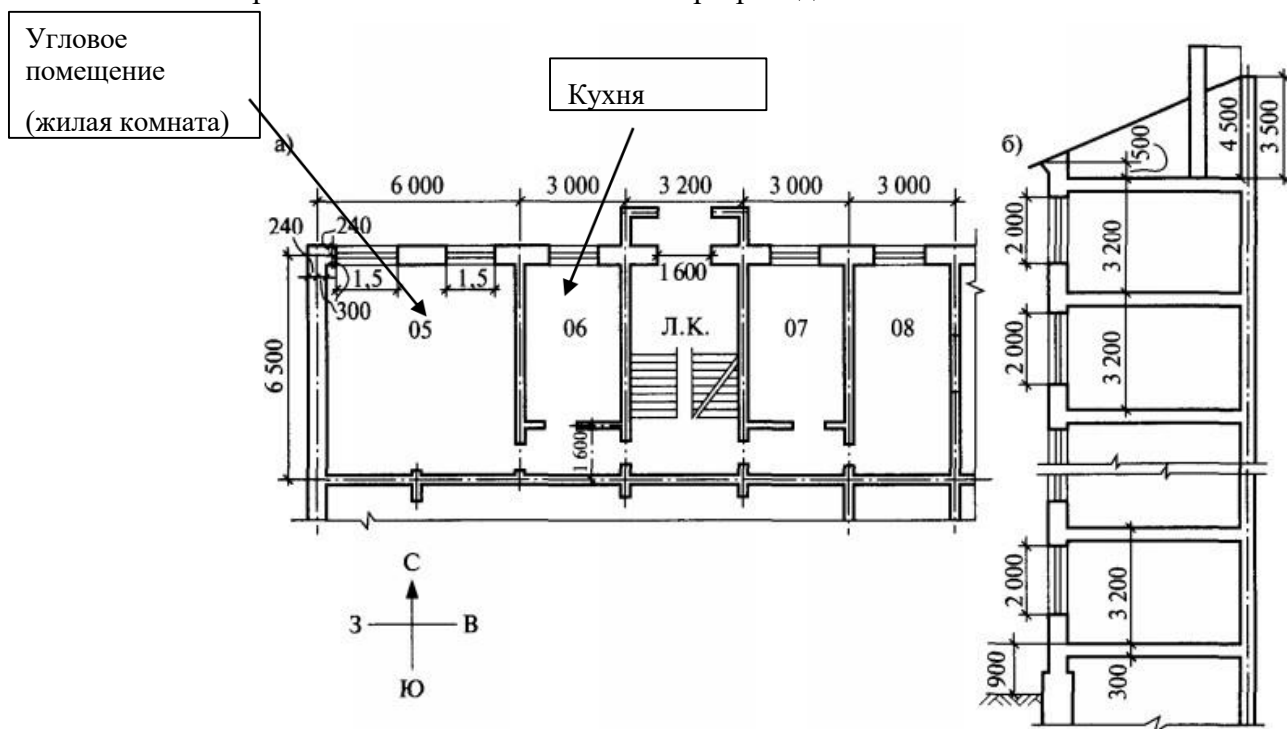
План и разрез здания: а – фрагмент плана этажа; б – разрез 1-1.
